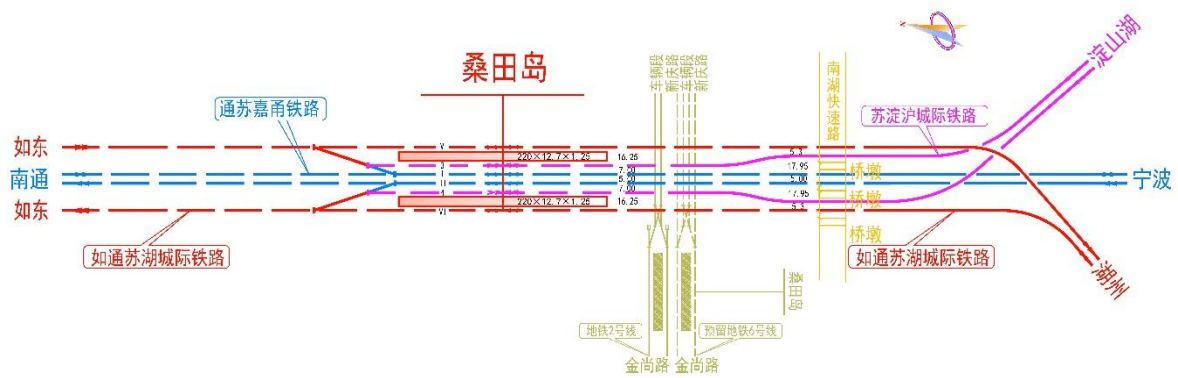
原可研桑田岛站 2 岛 6 线方案平面布置示意图
